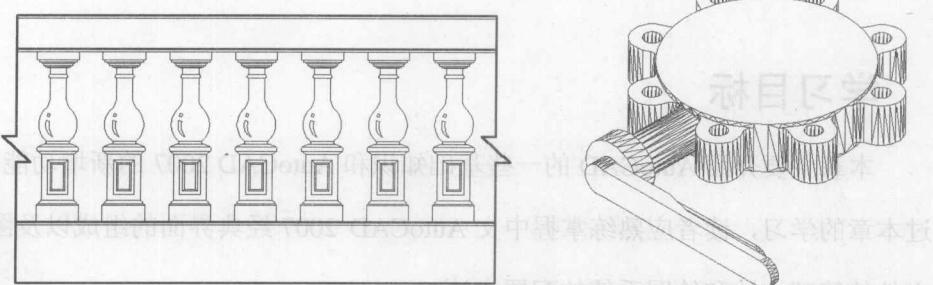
利用 AutoCAD 绘制的平面图形和三维图形
